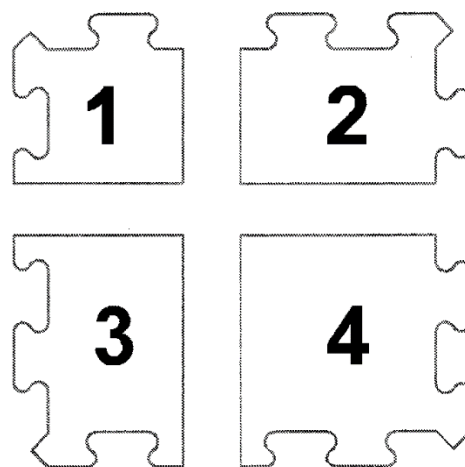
Montaż bocznych Płytek gumowych w kształcie Puzzle.
